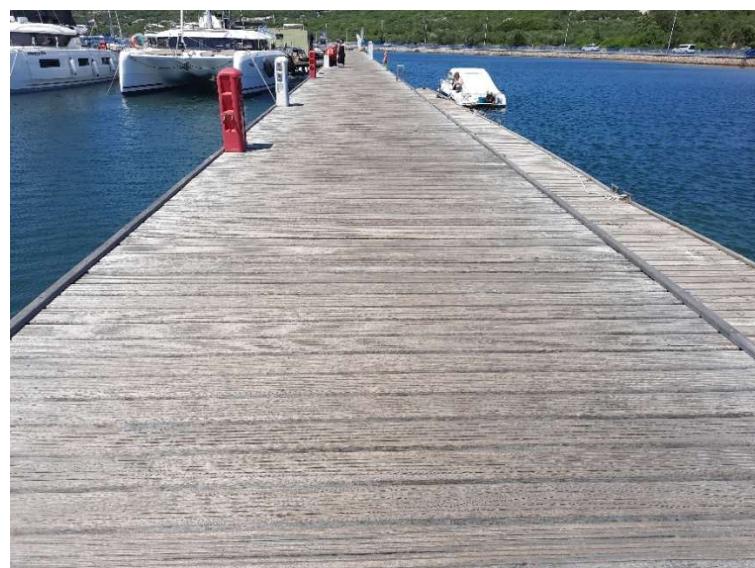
Fotografija prilazne rampe na gatu A6 (foto autor)
